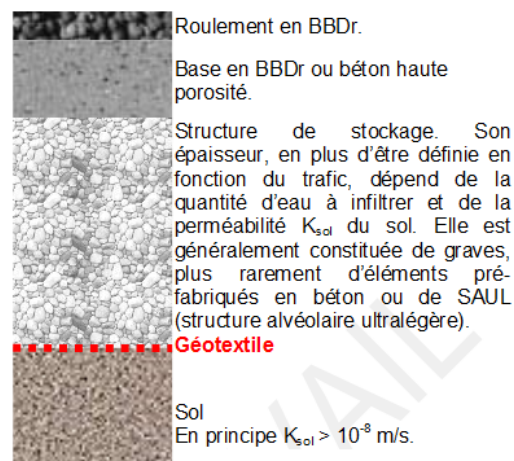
Exemple de structure de chaussée infiltrante avec couche de roulement en béton bitumineux drainant (BBDr)
